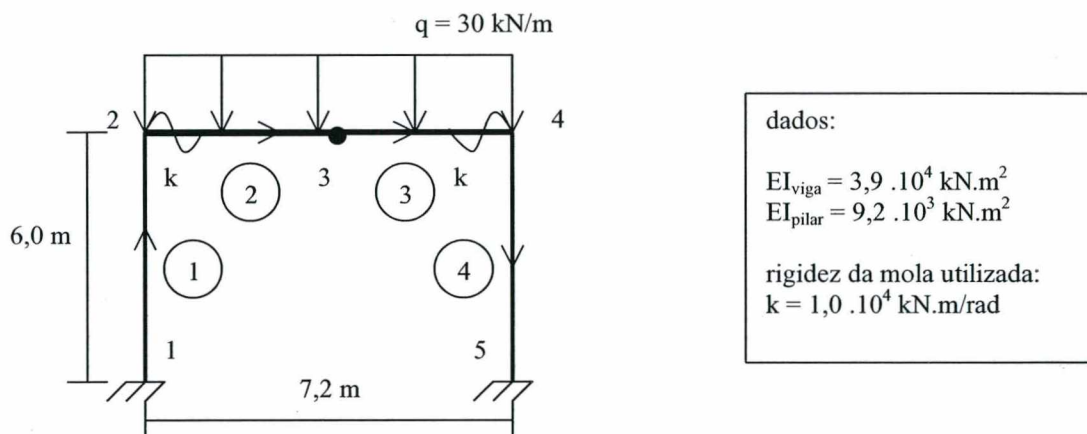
Pórtico plano bi-engastado, com carregamento uniformemente distribuído com “molas”, somente no elemento viga.
